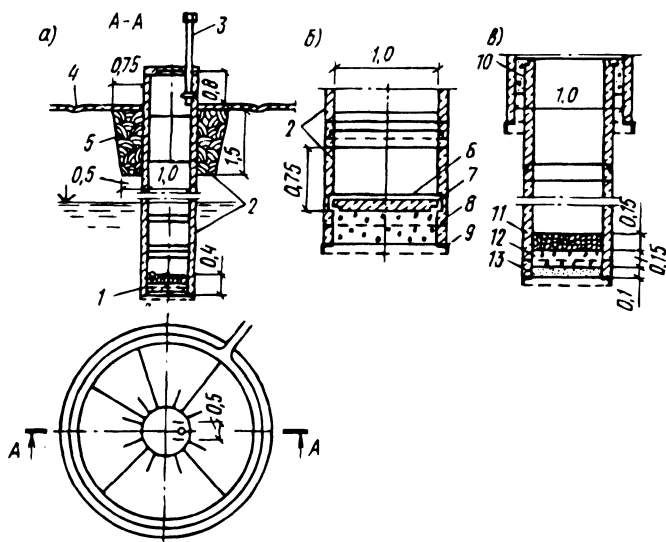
Конструкция шахтного колодца из сборных железобетонных колец:
